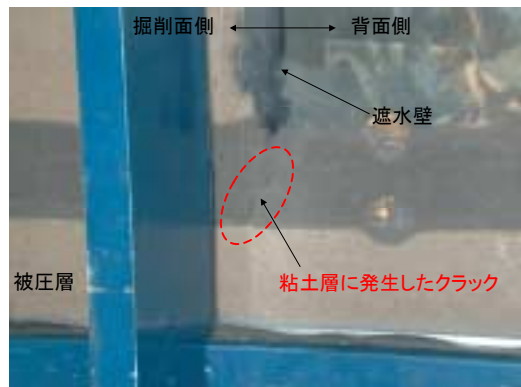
粘土層に見られた縦方向のひび割れ
